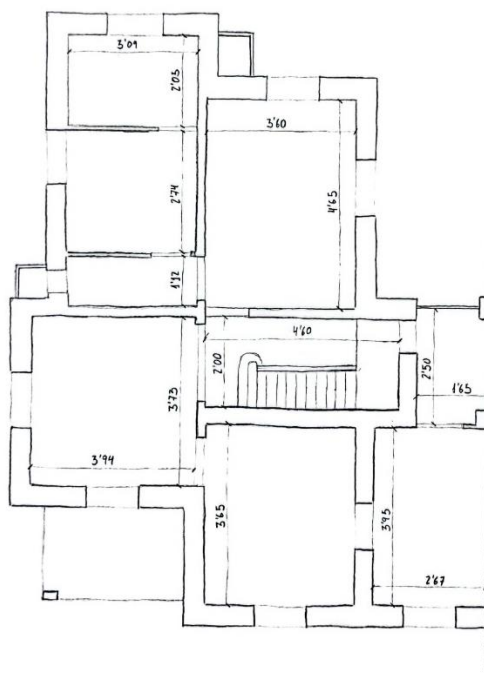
Croquis planta baja (Fuente: Elaboración propia)
